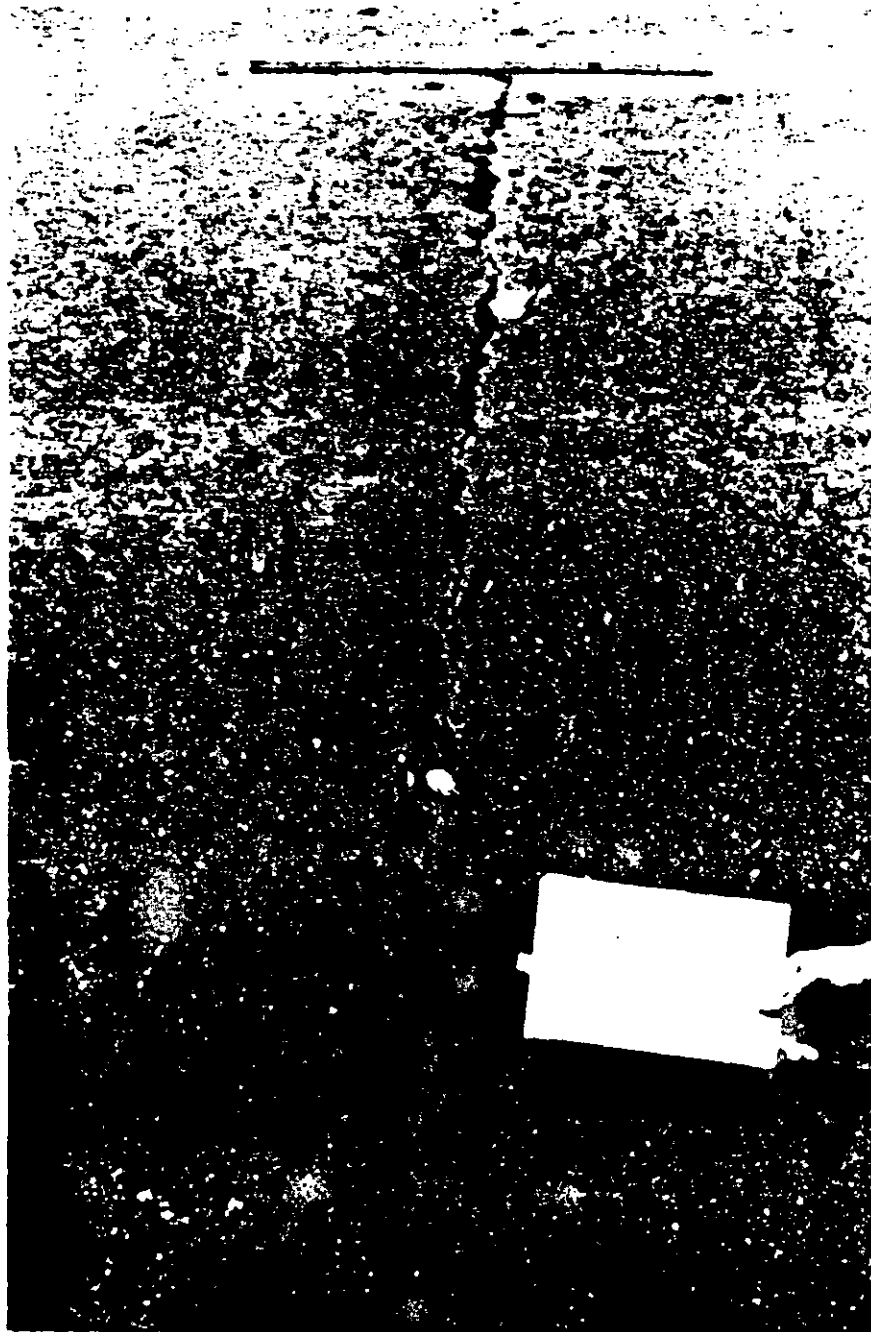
31 Grieta longitudinal acompañada de ligeras deformaciones. La introducción del agua de lluvia a través de la grieta hace más críticas las condiciones de trabajo del pavimento
